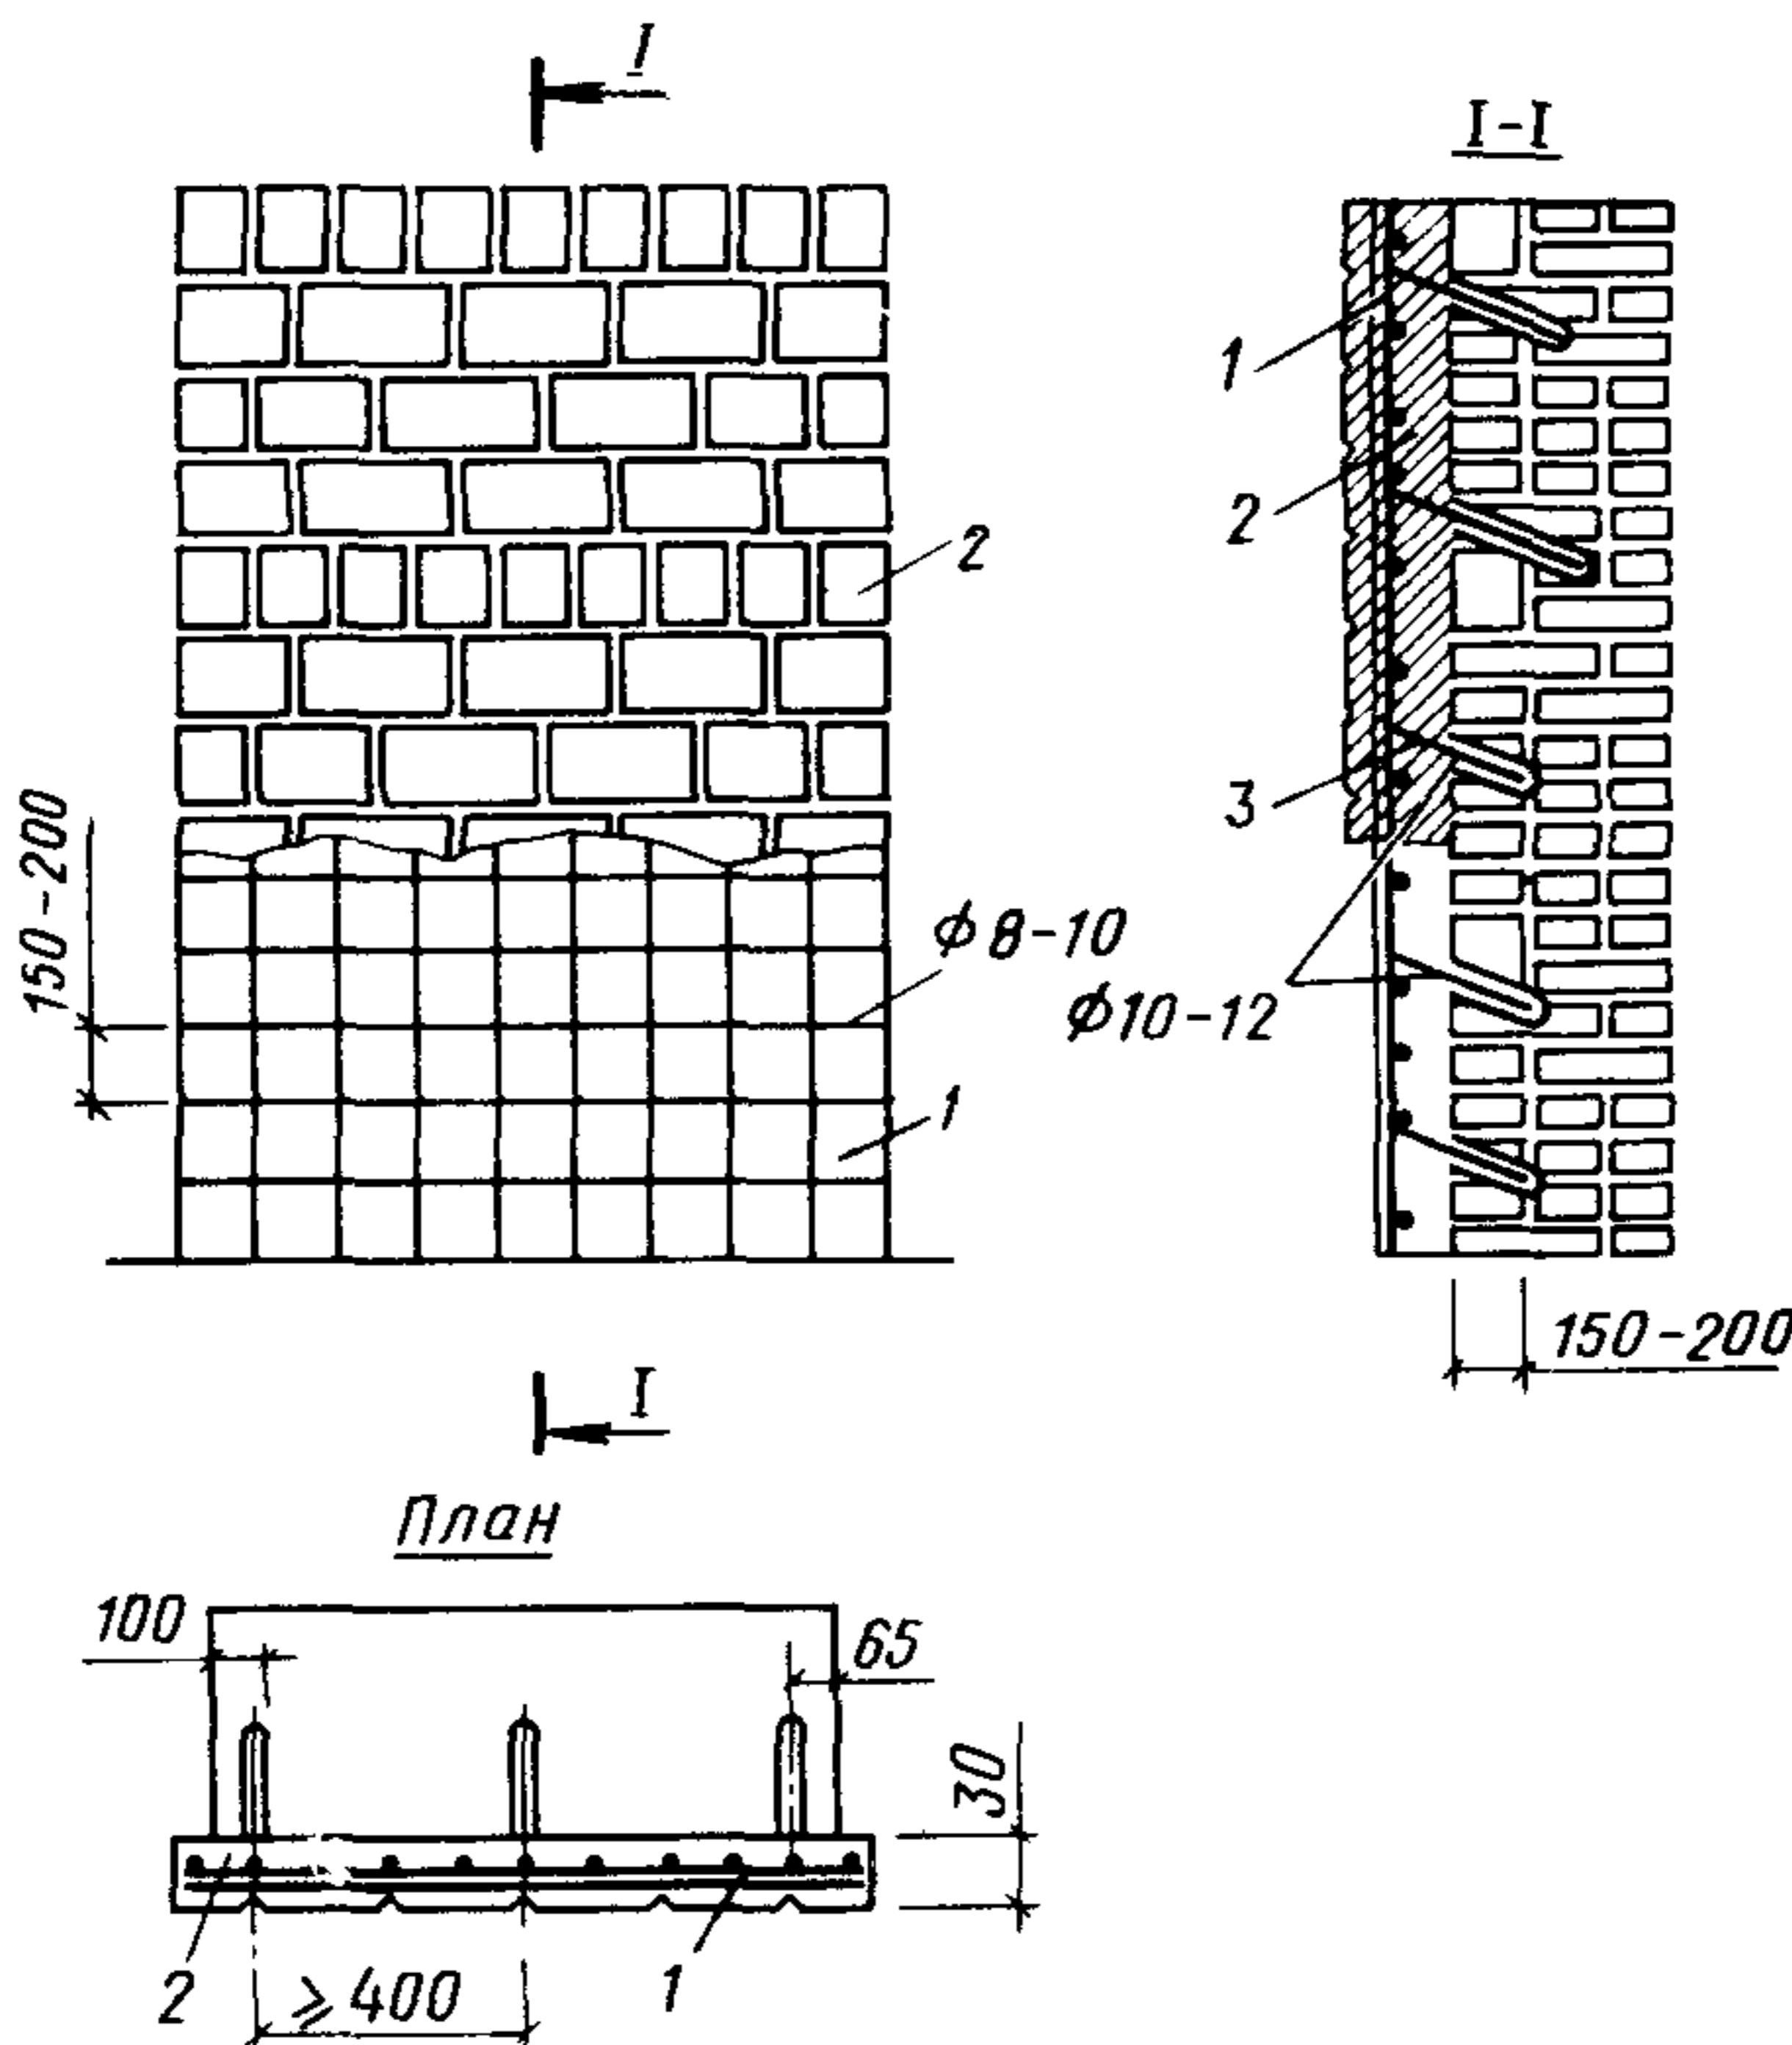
Пример усиления простенка путем замены разрушенной облицовки железобетонной стенкой
